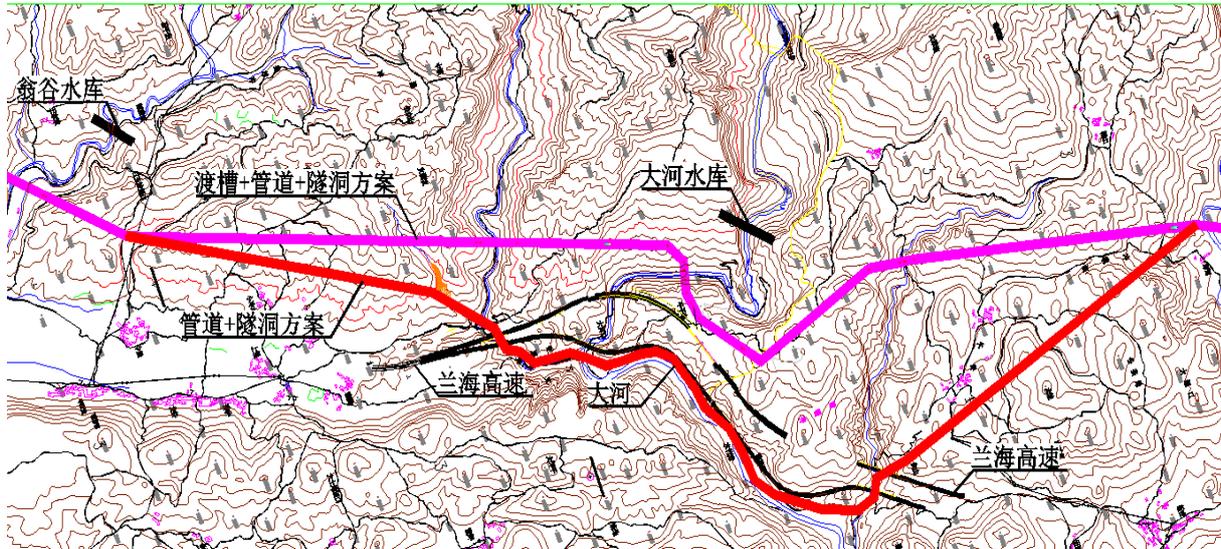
大河水库部位局部输水线路比选平面布置图
